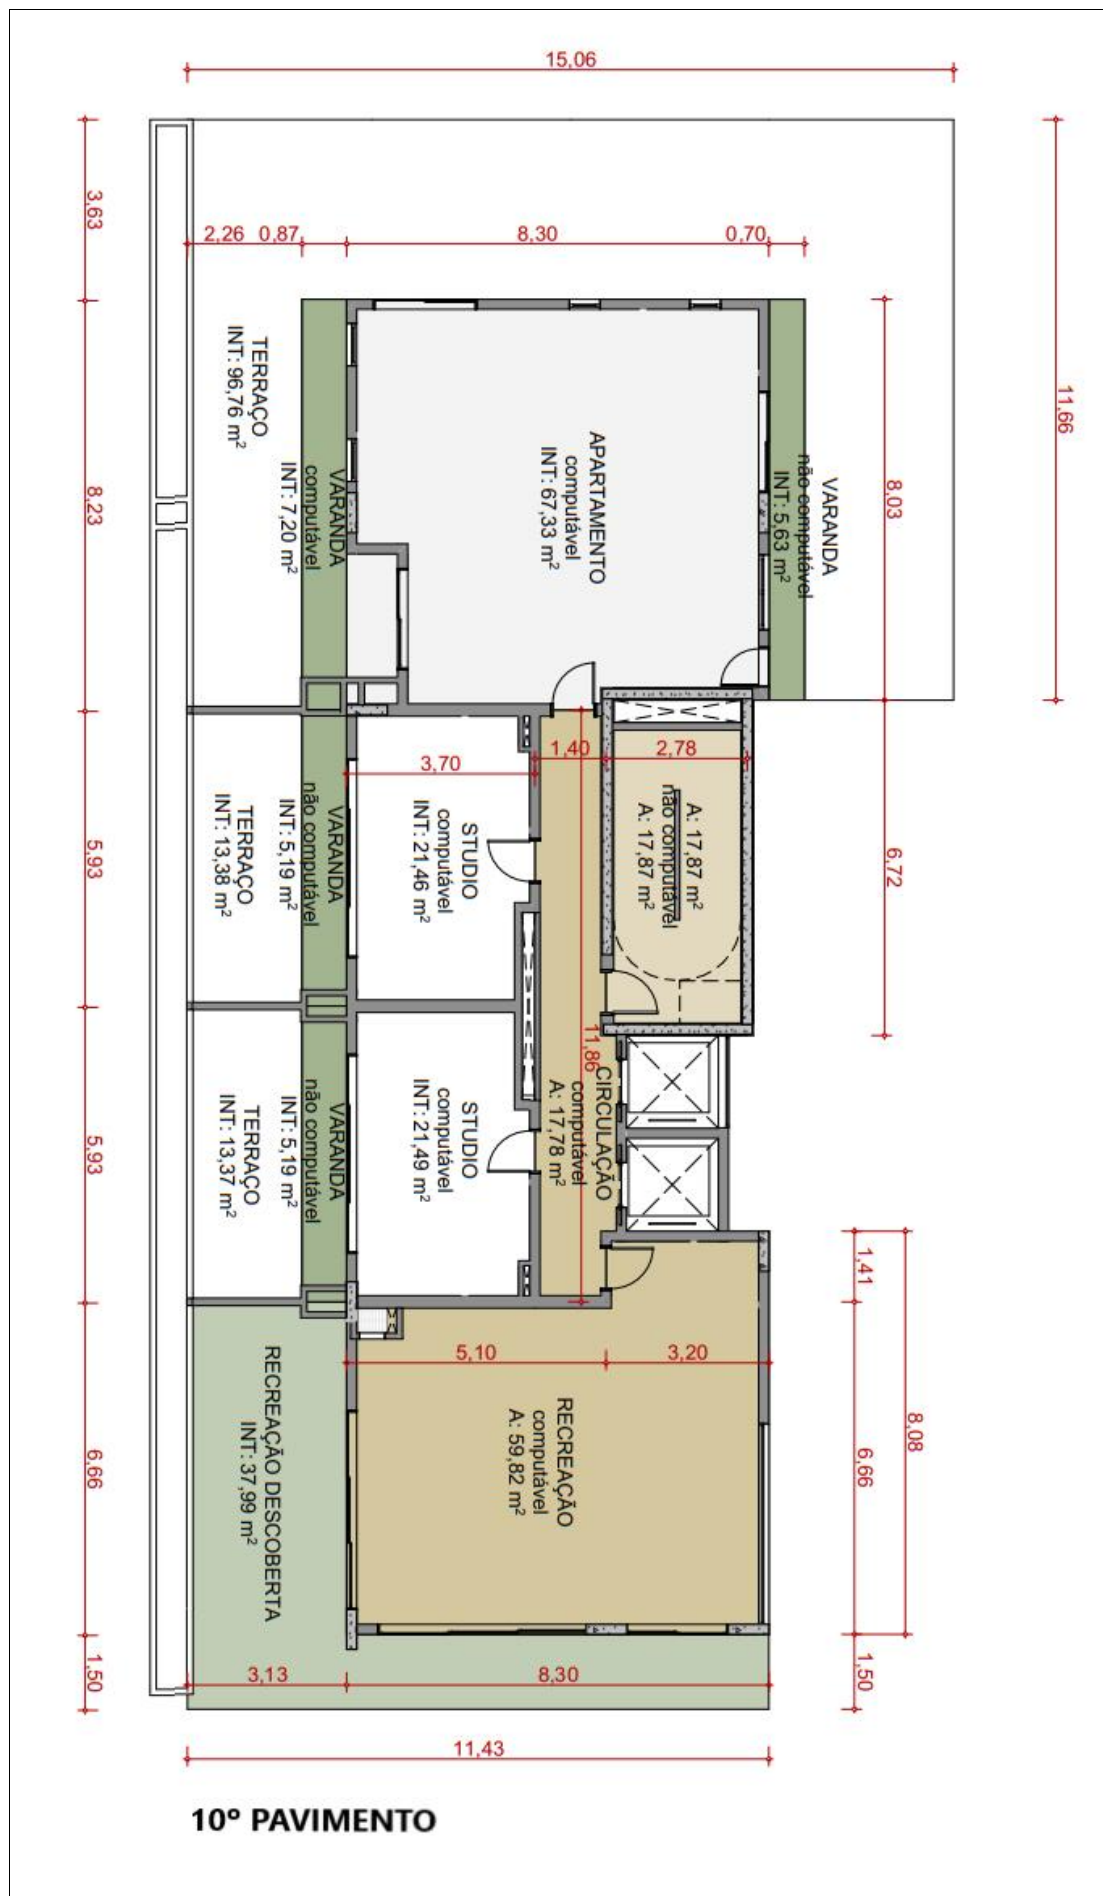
Planta do 10º Pavimento do Condomínio Sintropia Sky Garden.
